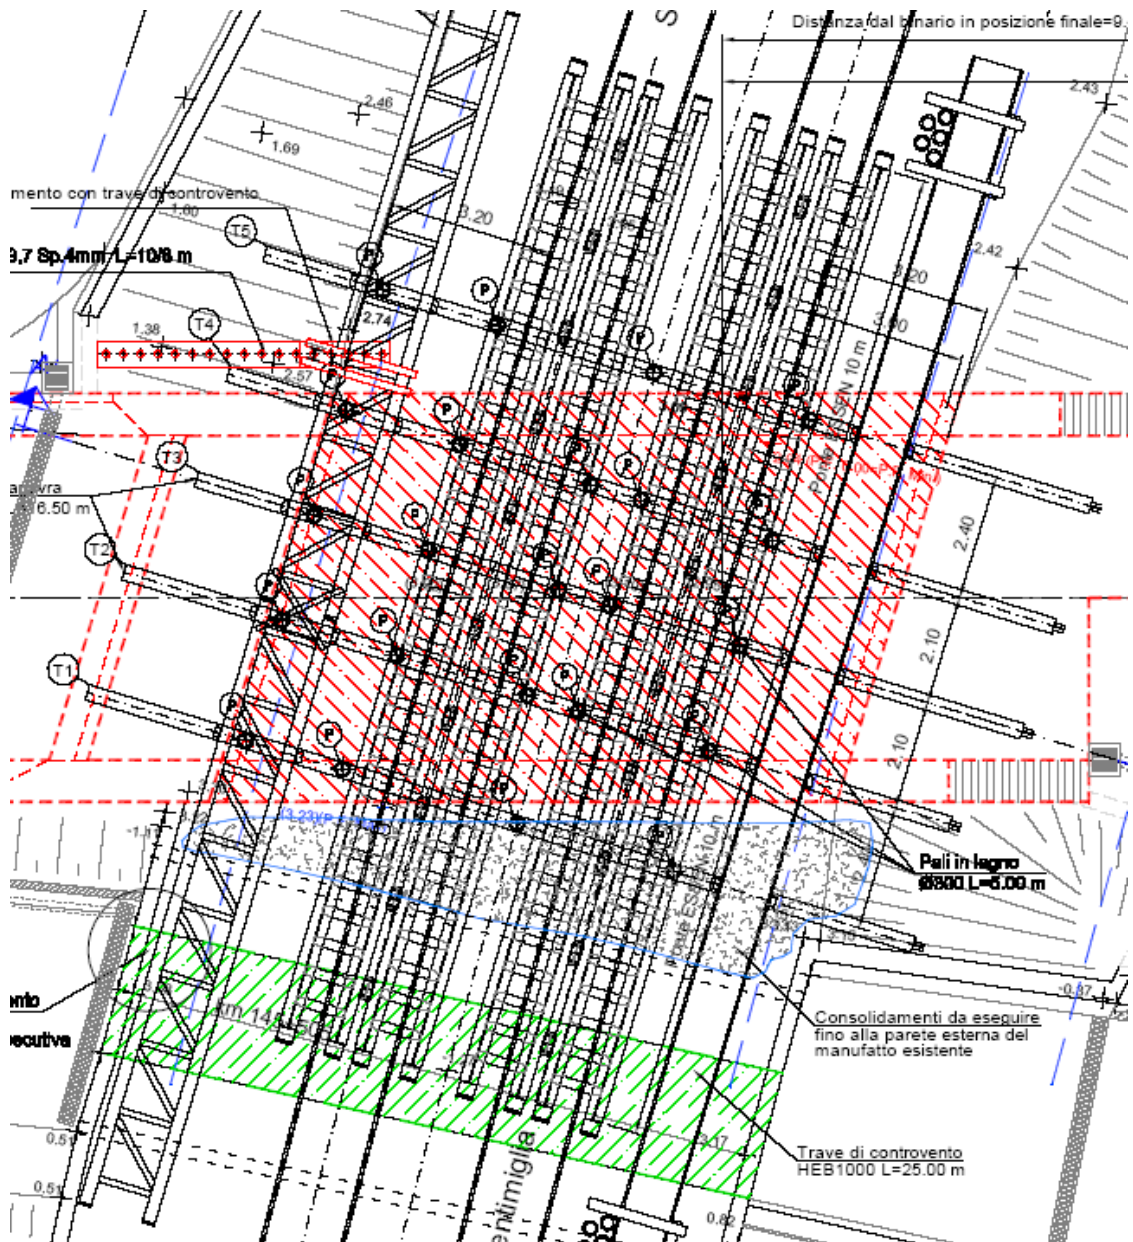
Visione planimetrica tipo del Sistema Essen
